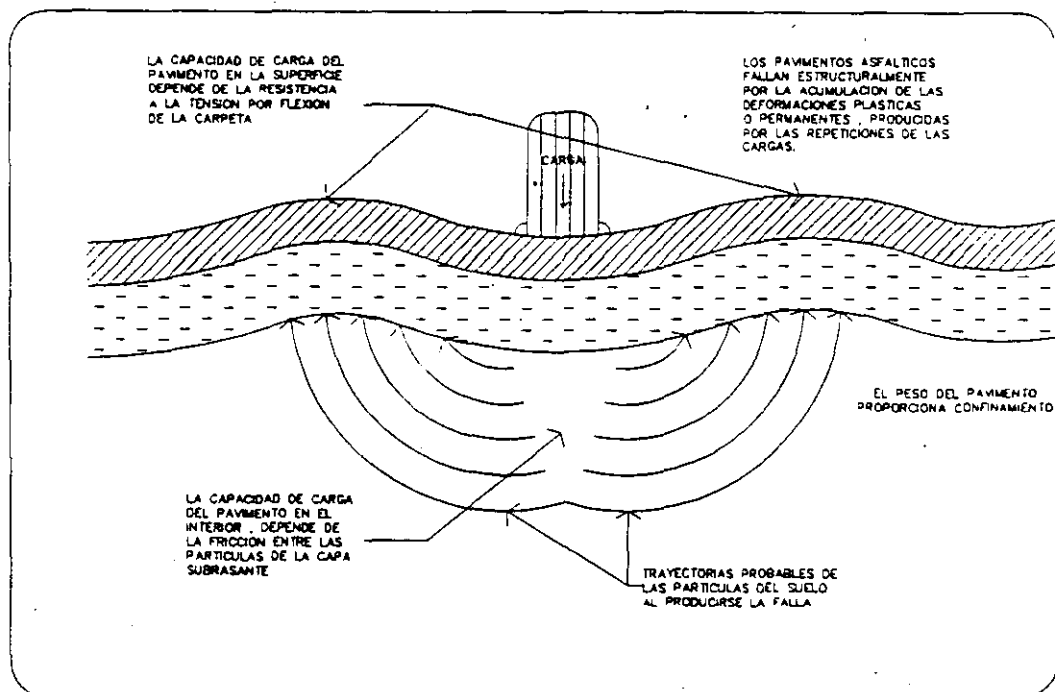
Falla estructural del pavimento asfáltico.
